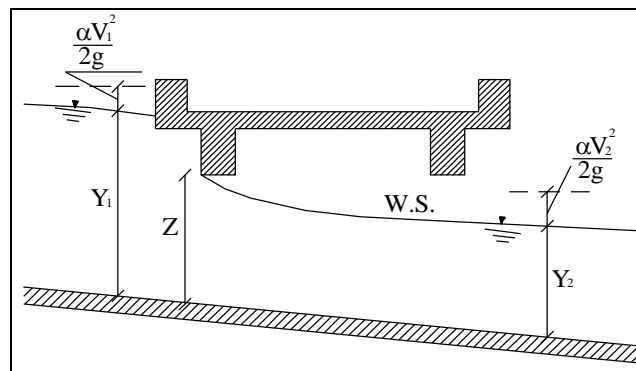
Sezione schematica di un ponte – Schema di calcolo
